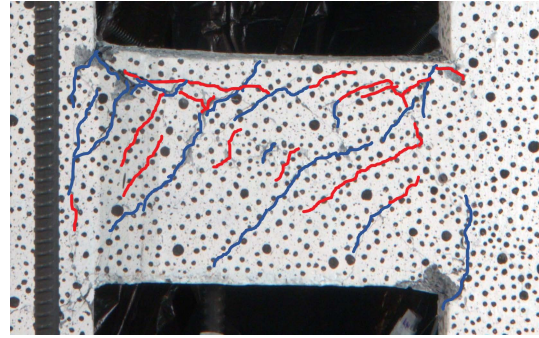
Grietas Vigas a -1.35 % Drift
